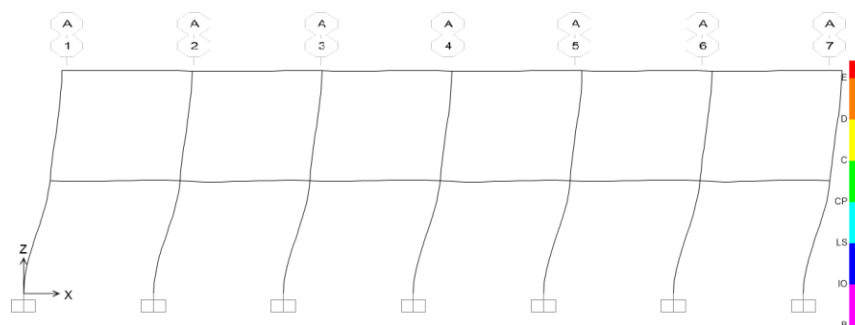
Deformada del pórtico A (frecuente). Fuente: Propia.
